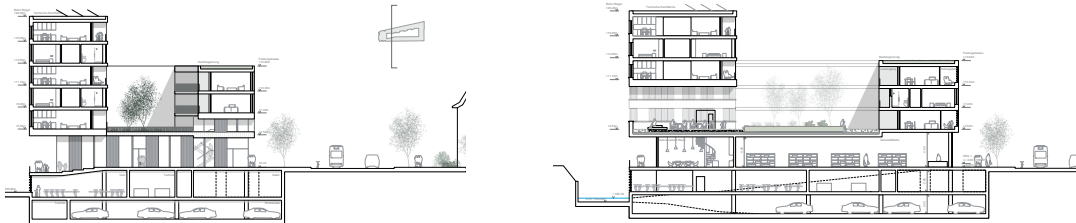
Querschnitte (Nord-Süd) durch Hof resp. Laden im Erdgeschoss, West- und Ostfassade
